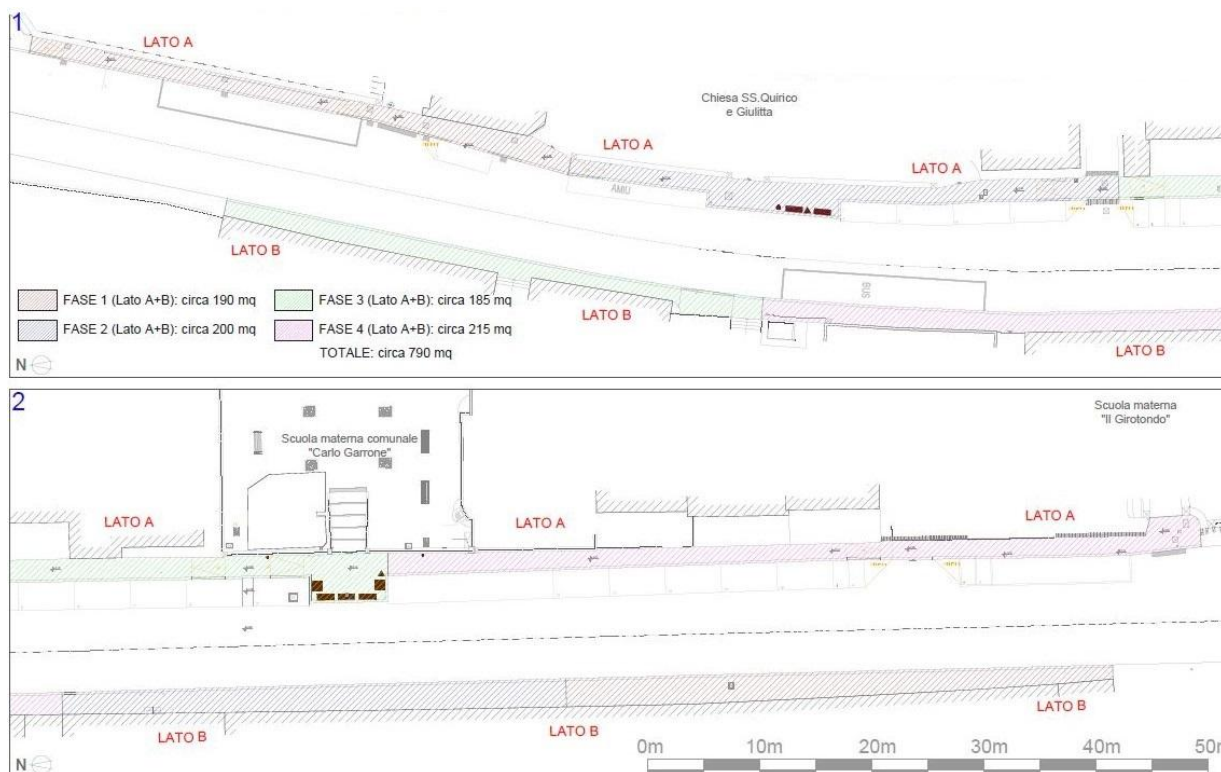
Estratto della Tav. D06 relativa alle Fasi di Cantiere
